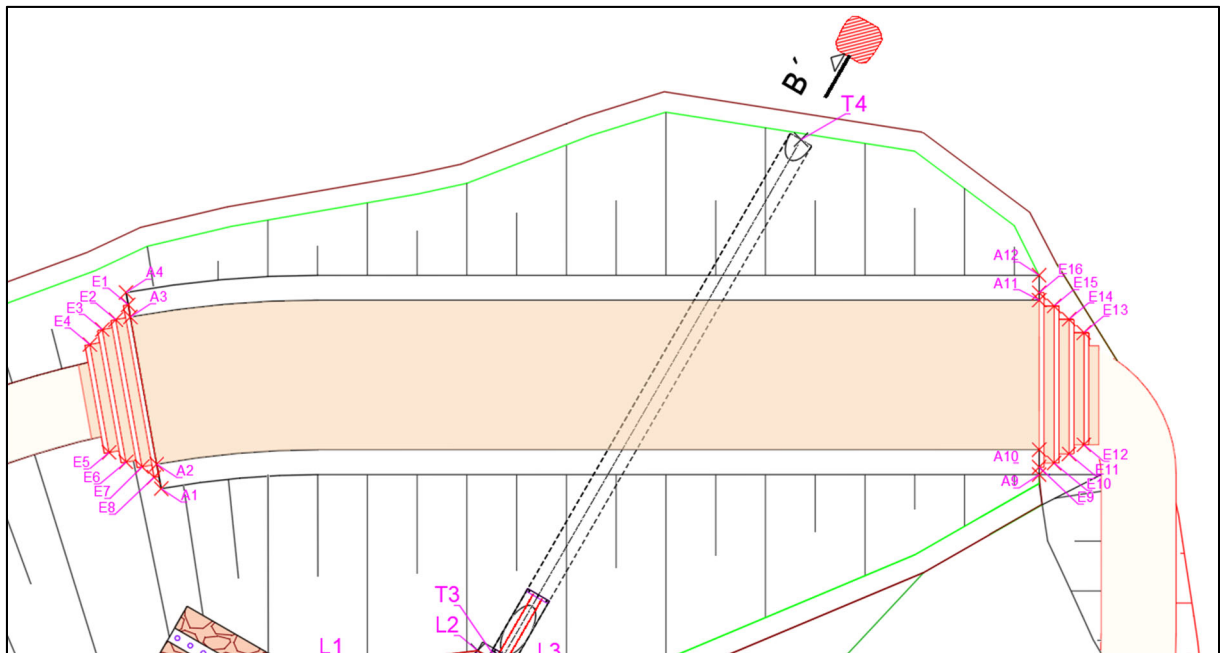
Vista en planta de las escaleras del dique inferior.
